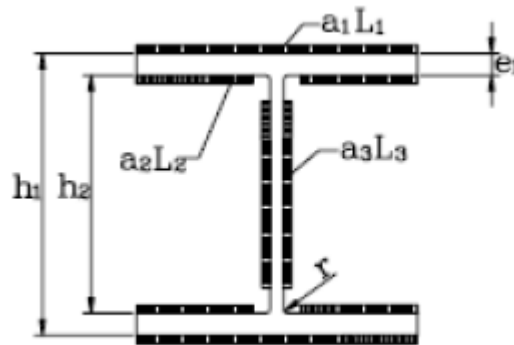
42. Predimensionamiento de cordones de soldadura.
